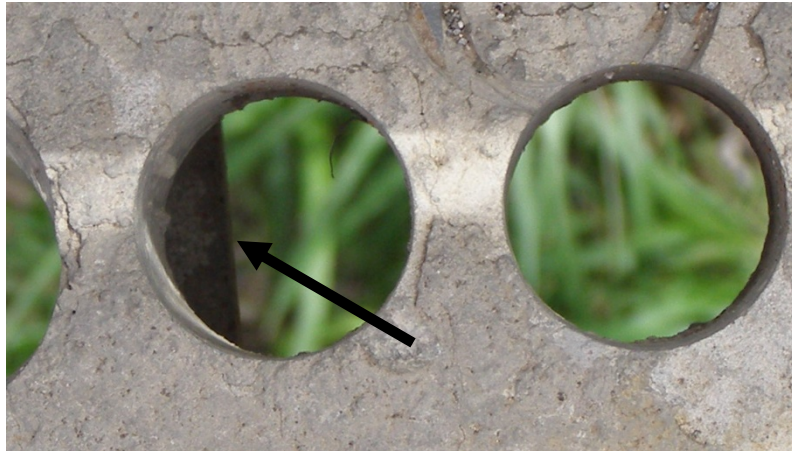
Superficie inferior de los drenajes en la calzada.
